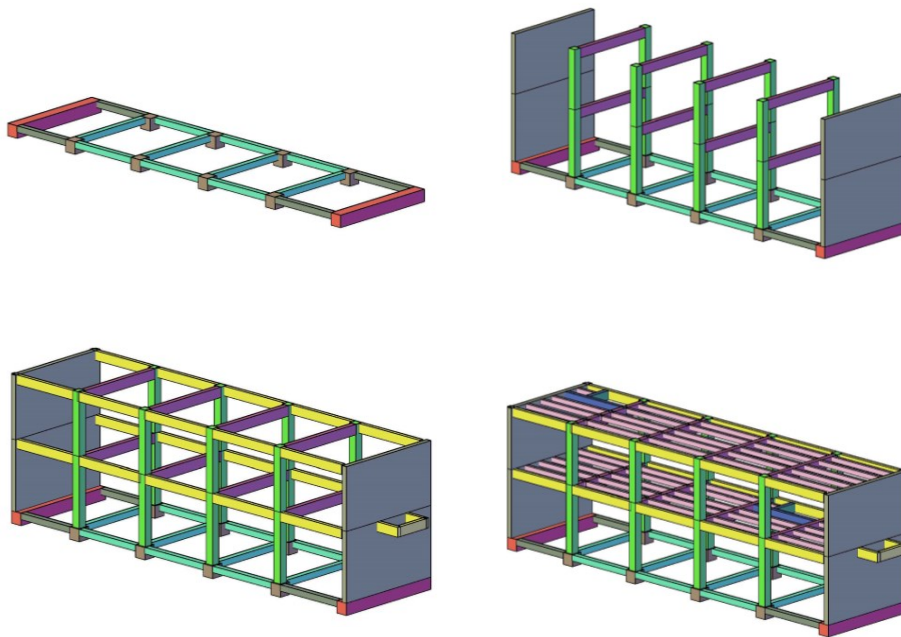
Análisis de la estructura de un edificio: cimentación, pilares, vigas y forjados.
